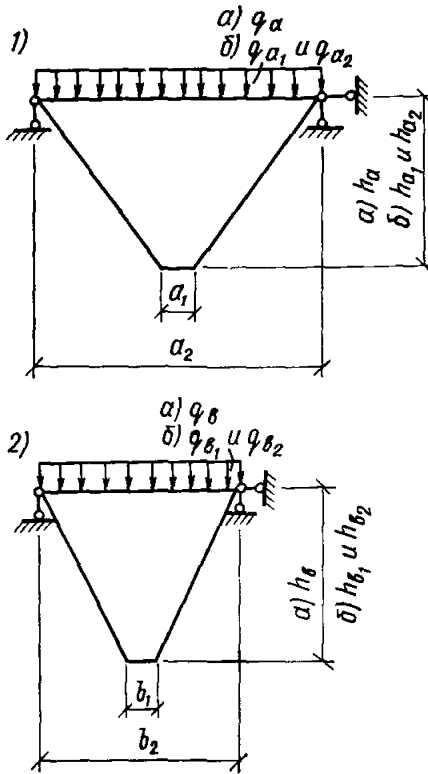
Расчетные схемы и нагрузки на треугольные балки-стенки при расчете на общий изгиб
